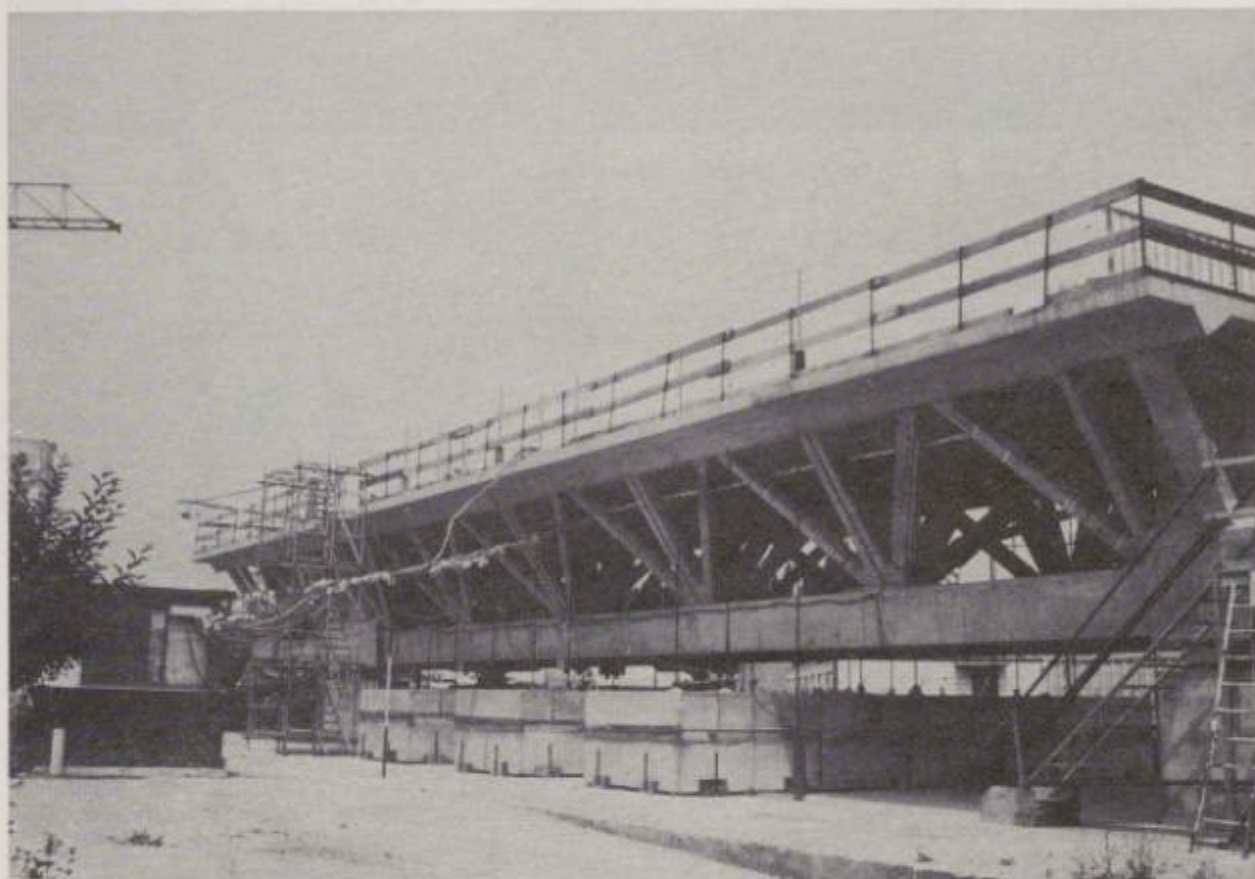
Maquette échelle 1. Vue d'ensemble.
